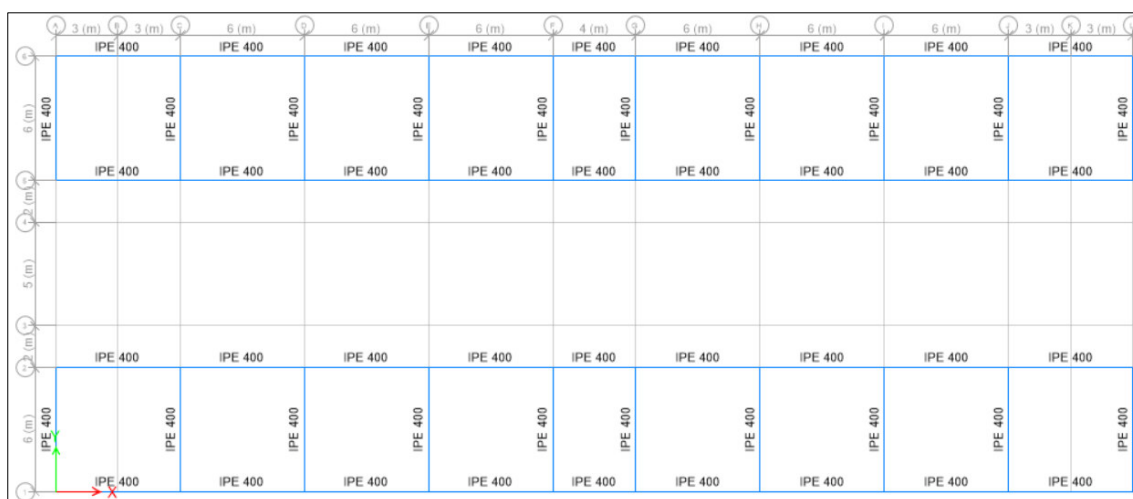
Distribución de vigas principales IPE 400 en losa superior.
